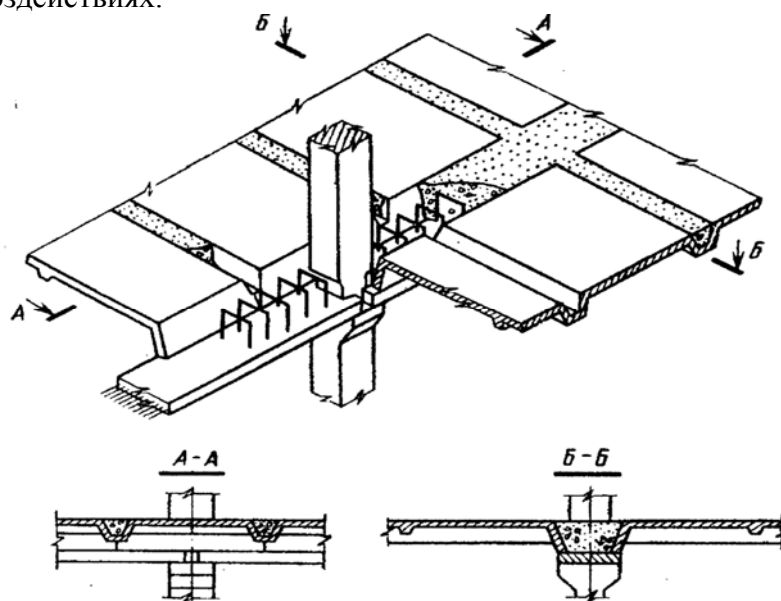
Ребристые сборно-монолитные перекрытия с остоном из железобетонных панелей
